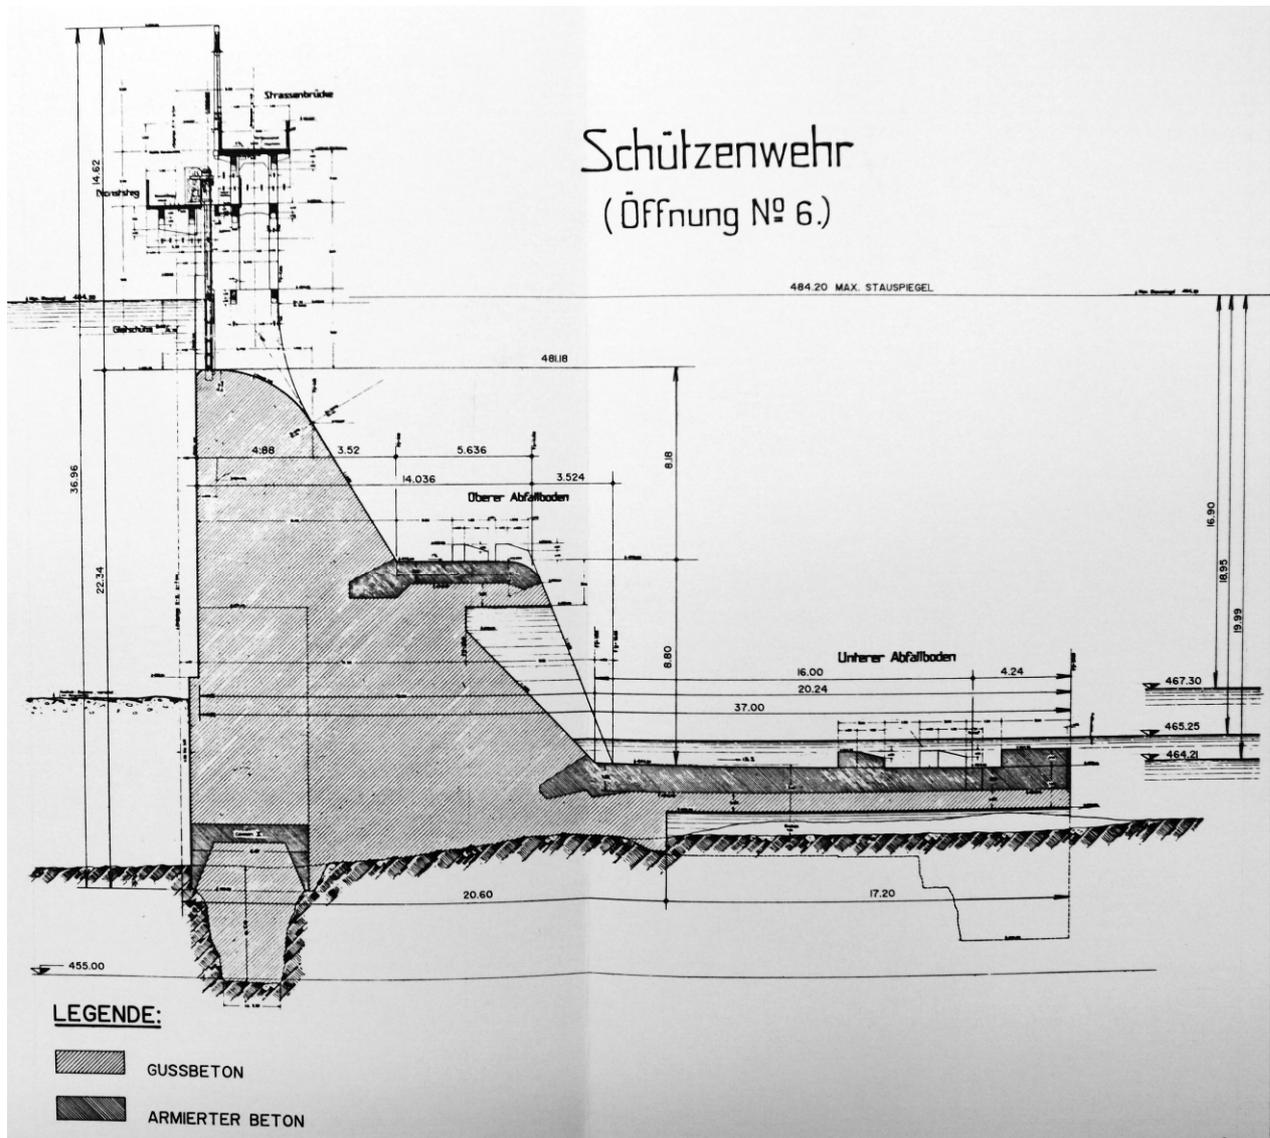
Ausschnitt aus Plan „WKW Mühleberg, Stauwehr Grundriss, Schnitt und Ansicht (Unterwasser)“, BKW, 17.4.1991 (offensichtlich Reproduktion von Plan mit Vermerk „Zürich, April 1922“), Staatsarchiv Bern, N P. Böhm 15
